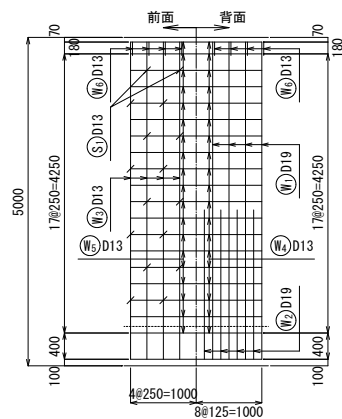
既設逆 T 型擁壁の配筋図 (たて壁)
